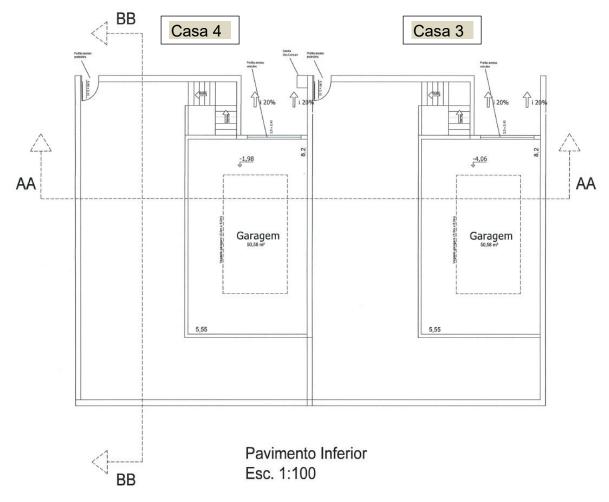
Planta Baixa Primeiro Pavimento Inferior – Estudo de Caso 2
